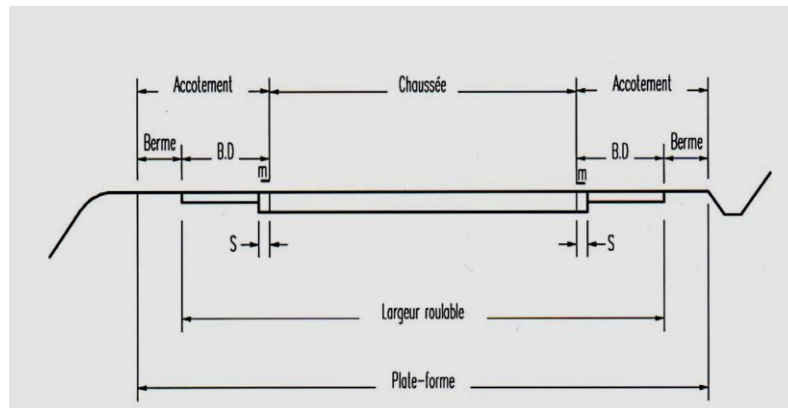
Cas d'une chaussée à 2 ou 3 voies (Visa ,2009).
